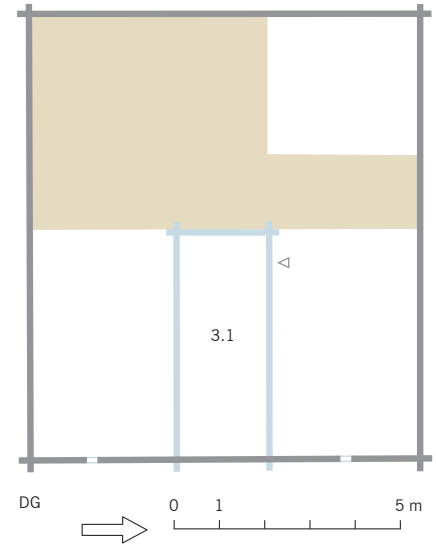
Haus Halthof in Menzingen, Grundriss des Dachgeschosses.
